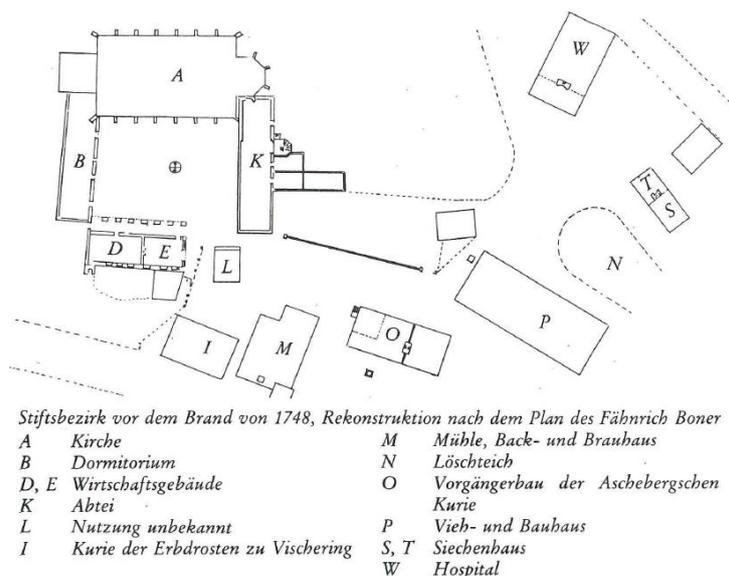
Historischer Grundriss Stiftsbezirk
